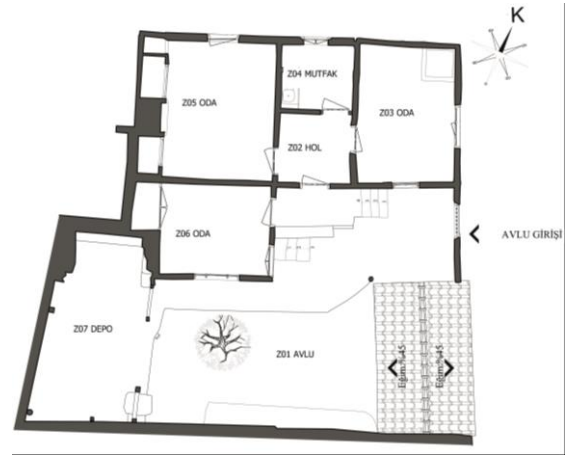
Kale İçi 2. Ev Vaziyet Planı [265, 272]
